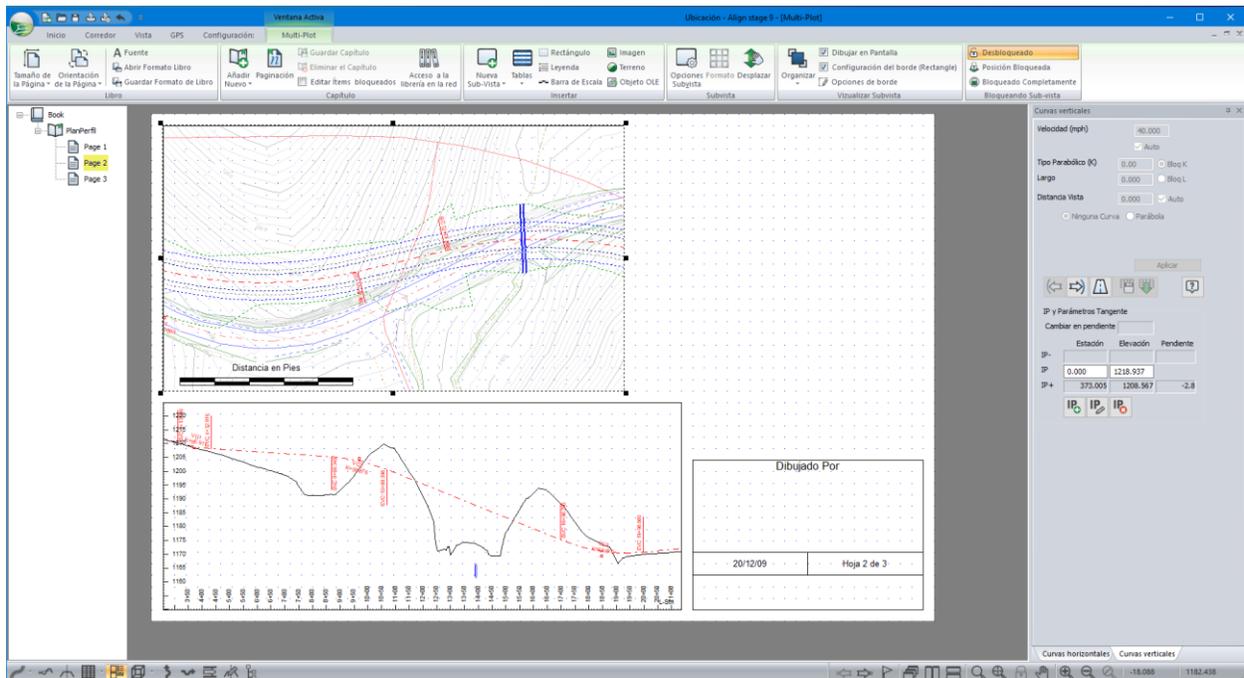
Sub-Vista de Planta Desplazada y Rotada
